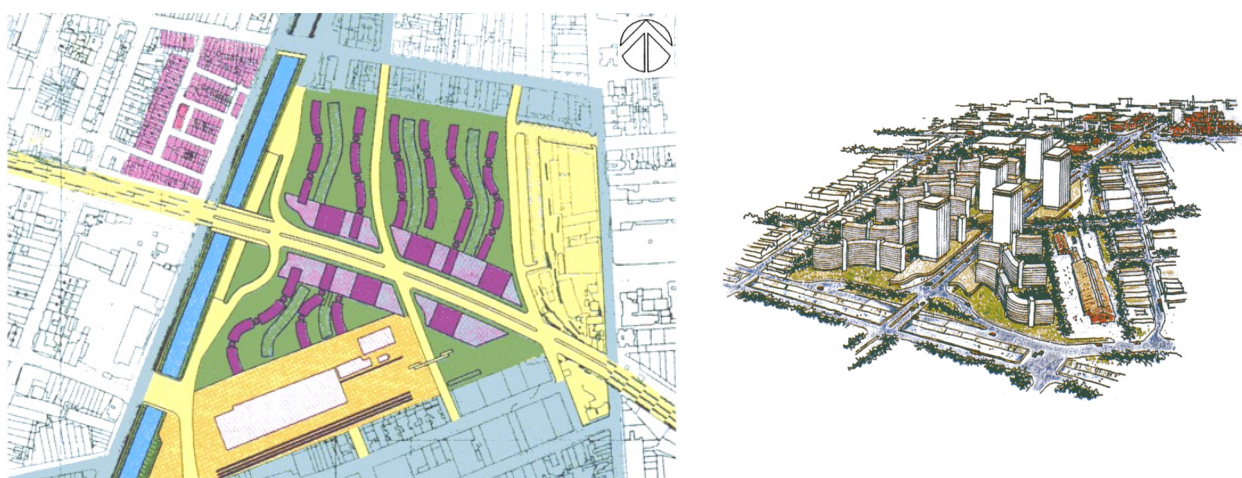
Implantação e vista Projeto Novo Centro (VA-12).
